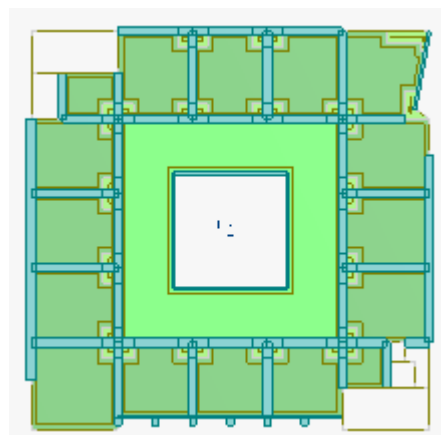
Vista de uma laje de piso com painéis e bandas de acerto.
